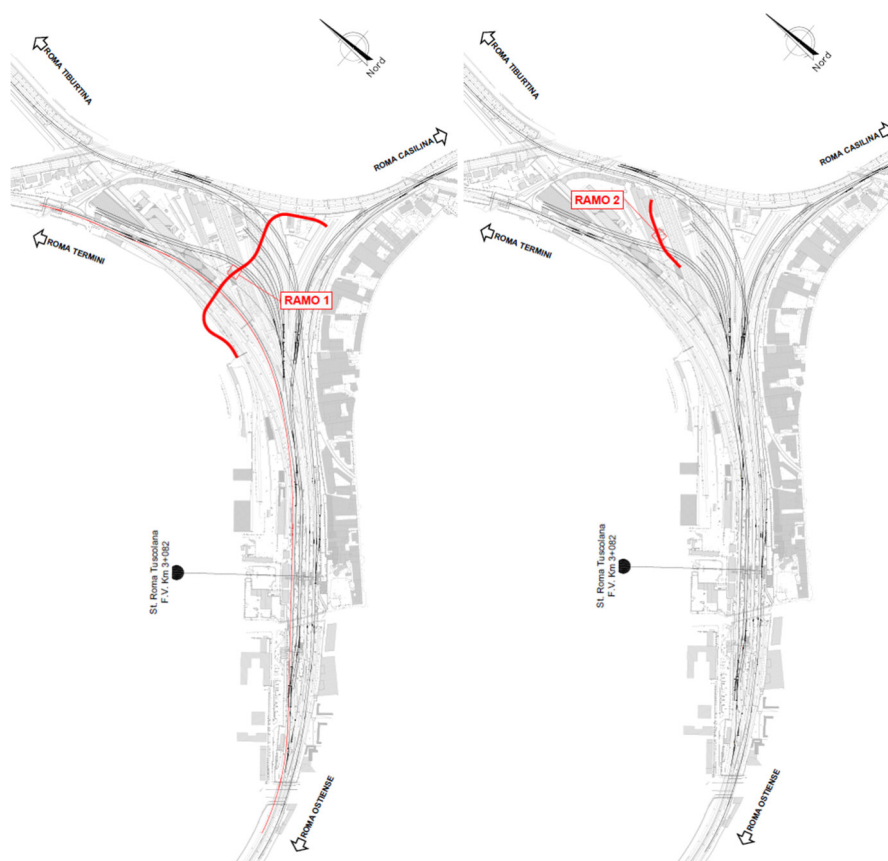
Planimetria di inquadramento del sottovia NG01.
